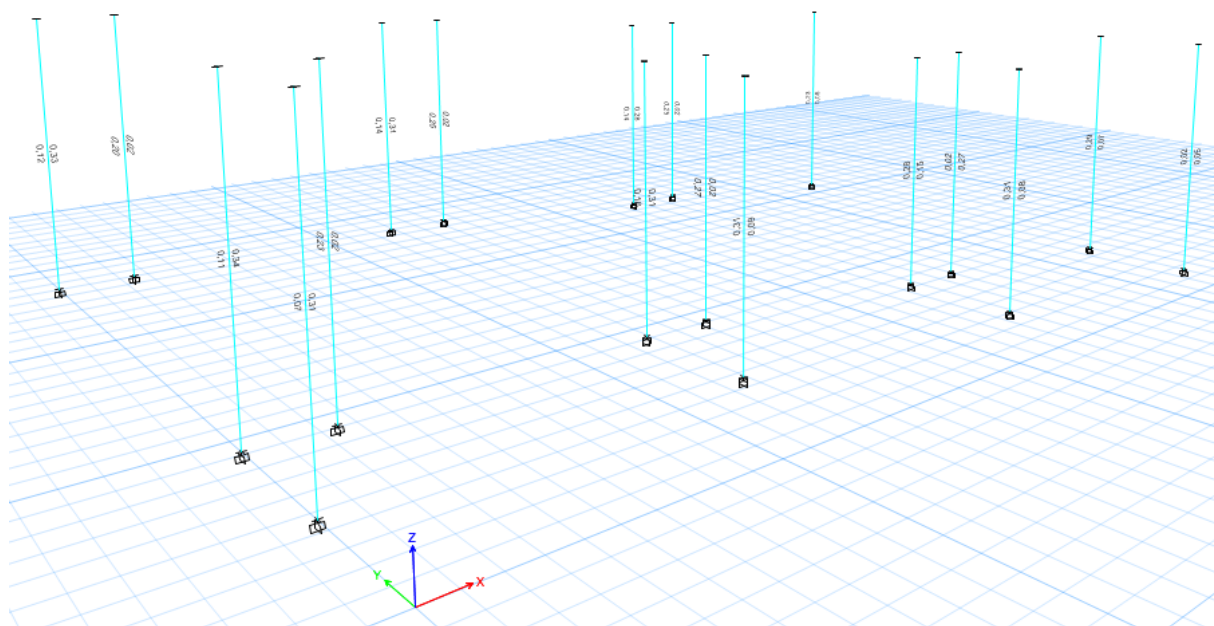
Refuerzo transversal en columnas de aulas de 1-11 en cm²
